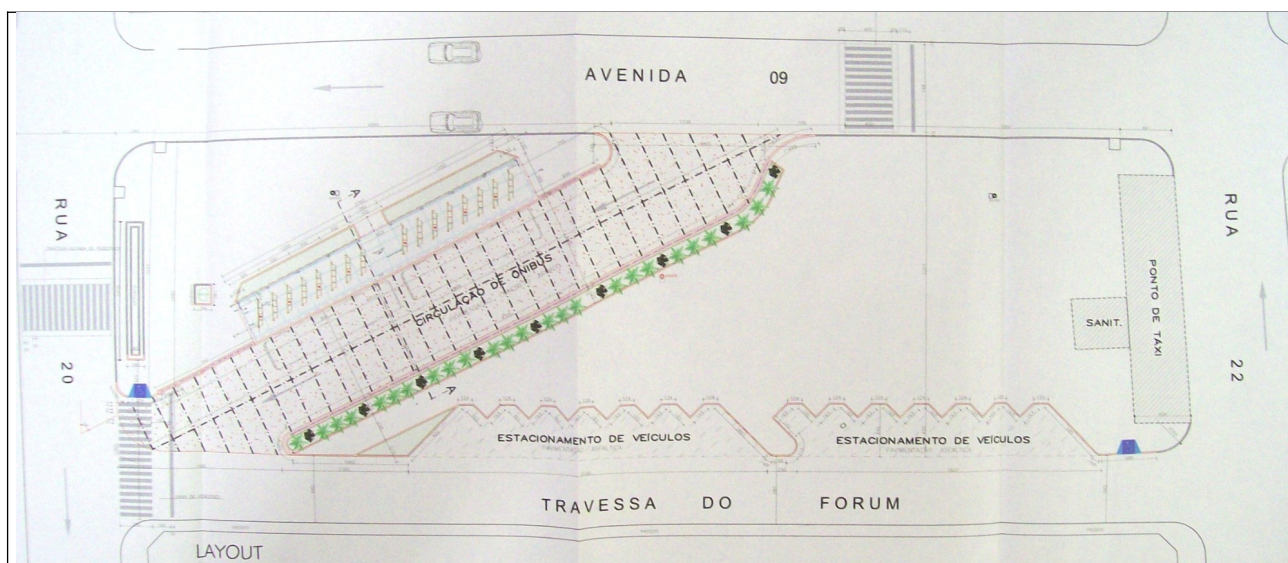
Planta layout do projeto de intervenção na Praça Adelino de Oliveira Carvalho.
